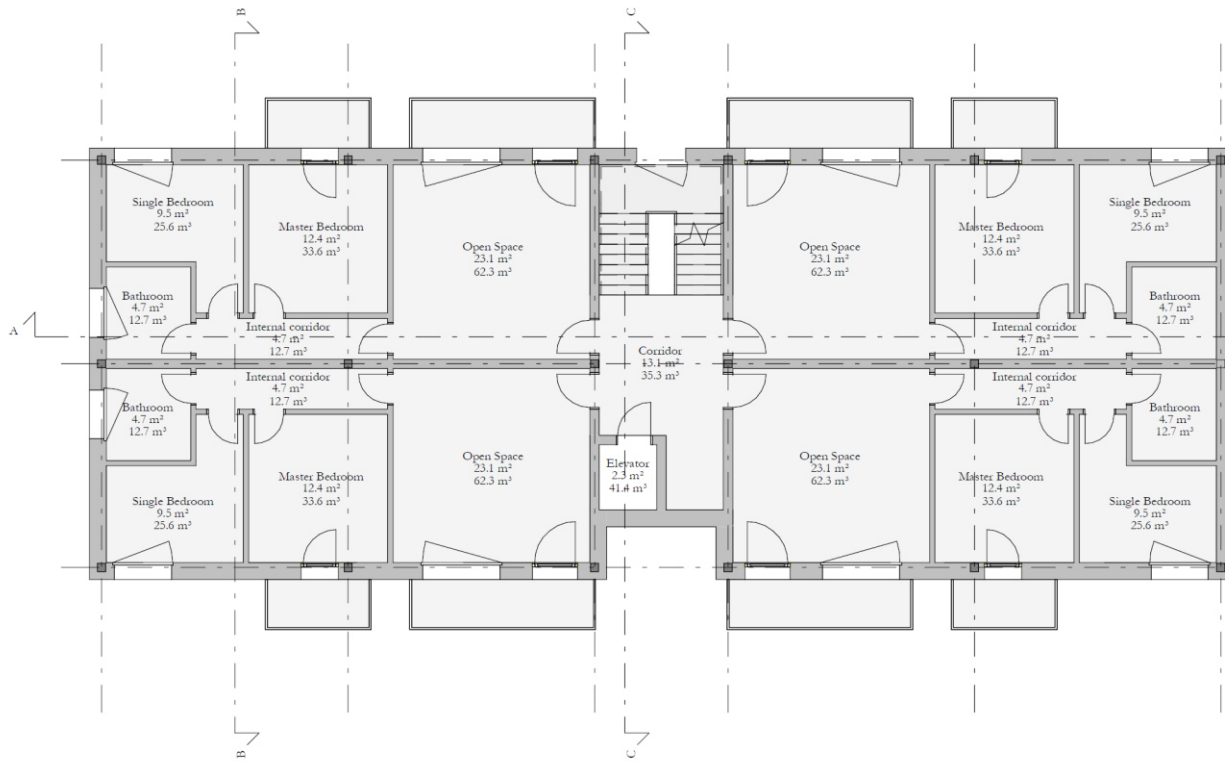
LRBo: pianta piano tipo, metà Ovest
